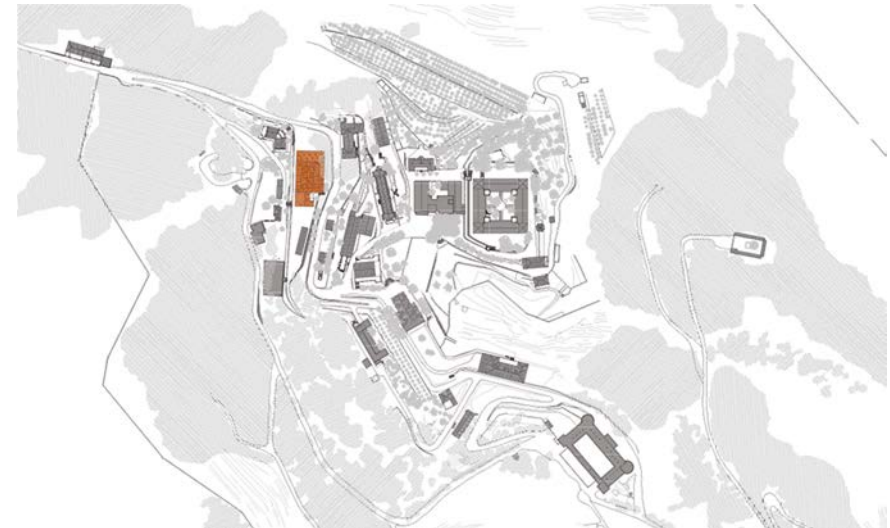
Plano de emplazamiento. Casa de Labor, actuales Garajes y Almacenes.
